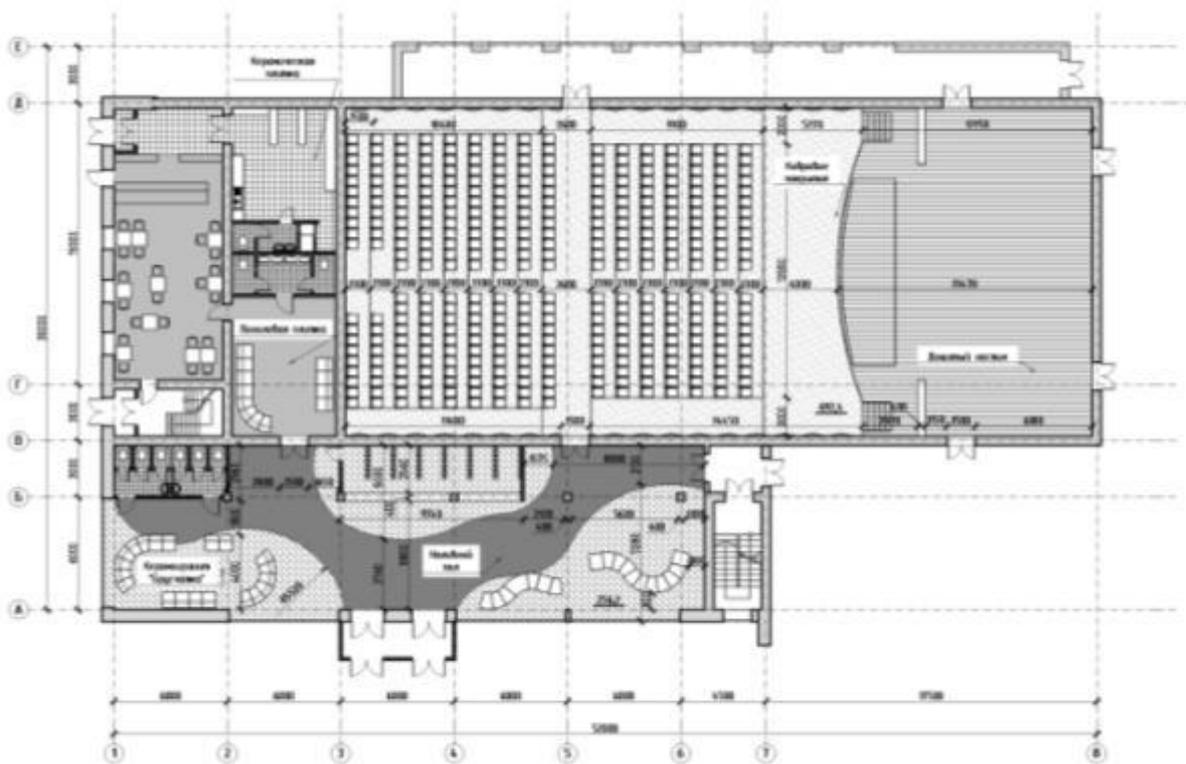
План пола с расстановкой оборудования. 1 этаж
